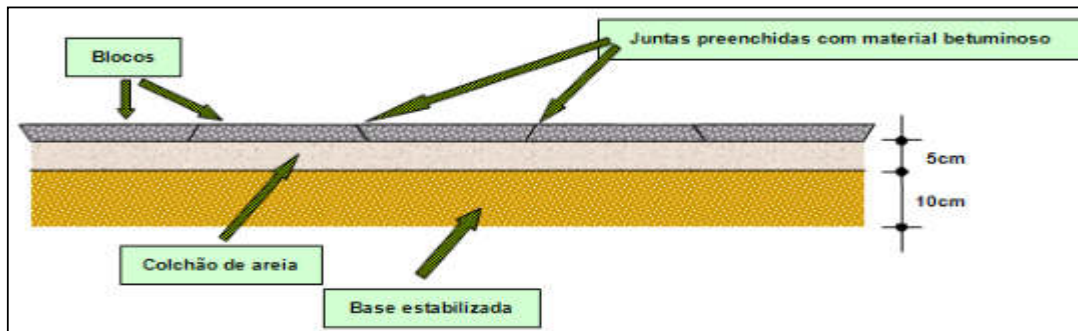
Pavimento em Blocos Pré-Moldados de Concreto (GEIPOT, 2001)
